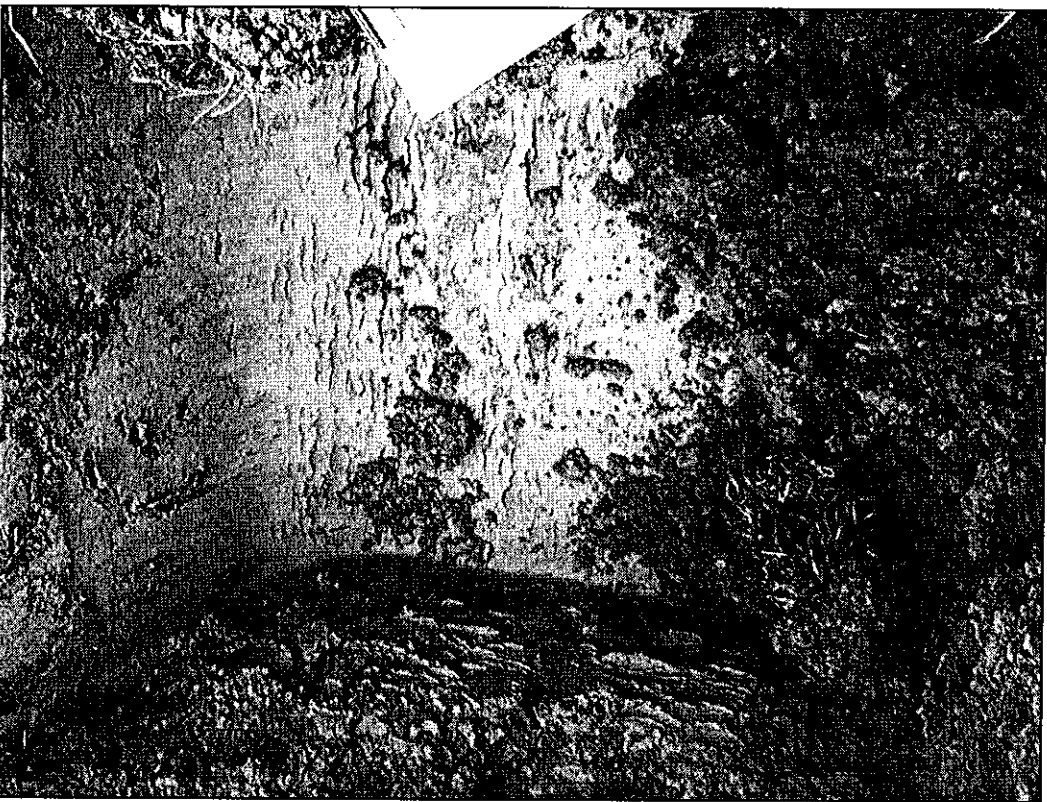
Pozzetto n° 15. Profondità -1.5 m dal p.c.
